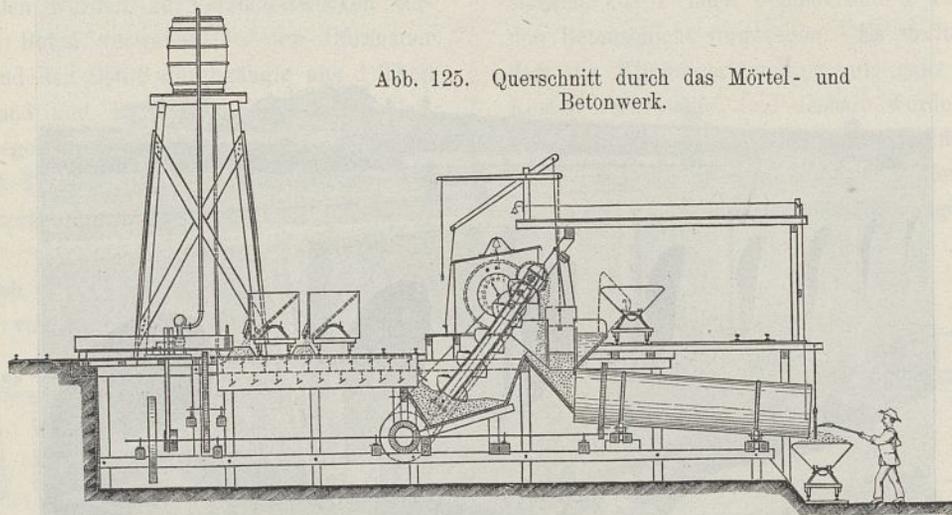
Querschnitt durch das Mörtel- und Betonwerk.
